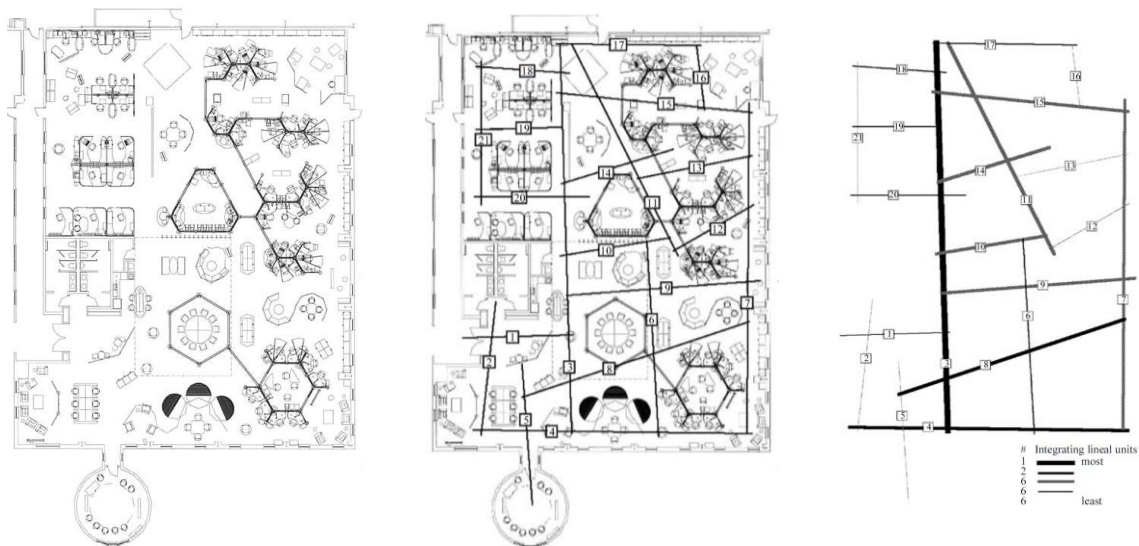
Strukturierung eines Büroraumgrundrisses mit einer «Axial Map» – links nur Grundriss, in der Mitte Grundriss mit Achsen, rechts nur Achsen mit Gewichtung (M. G. Brown, 2008, pp. 11, 18, 19).
